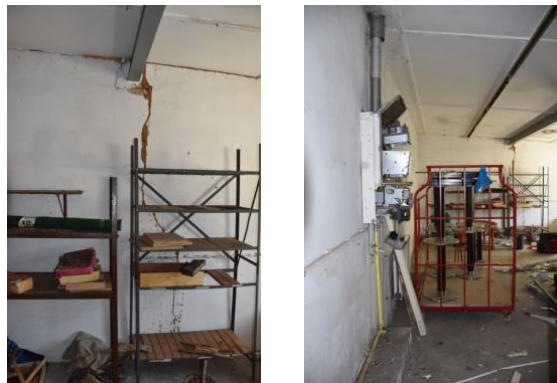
+ 9: Innenfoto Schäden (Risse, defekte Therme)
